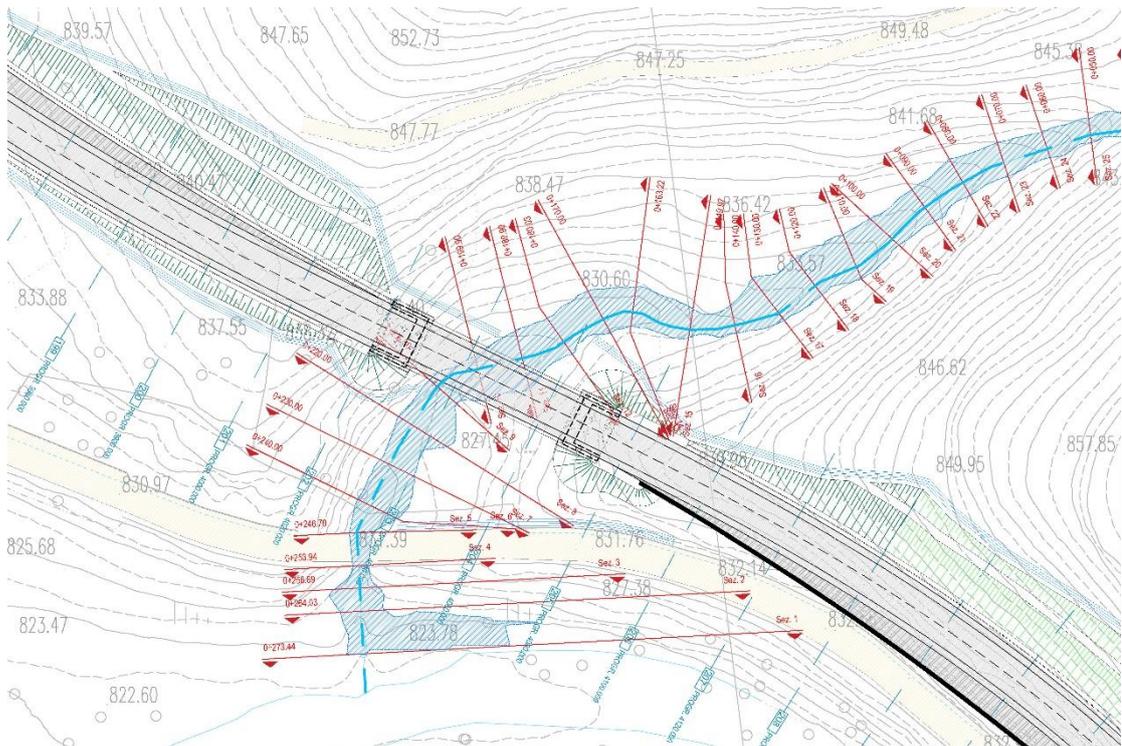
Fiume 17760 – Planimetria aree di esondazione.
